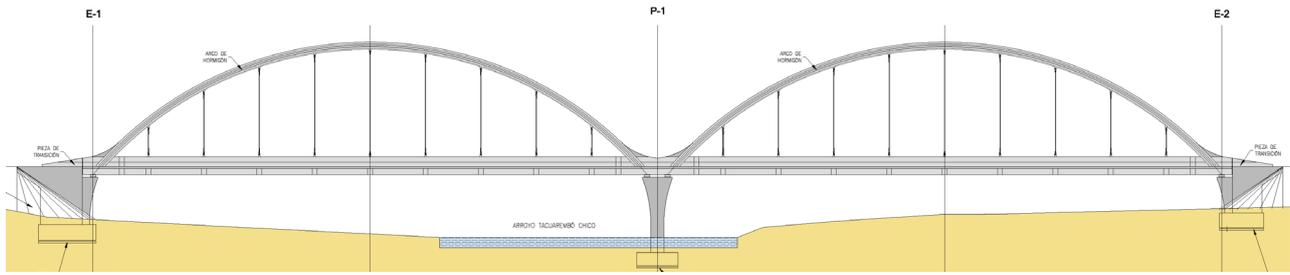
Alzado del puente sobre el Arroyo Tacuarembó.
